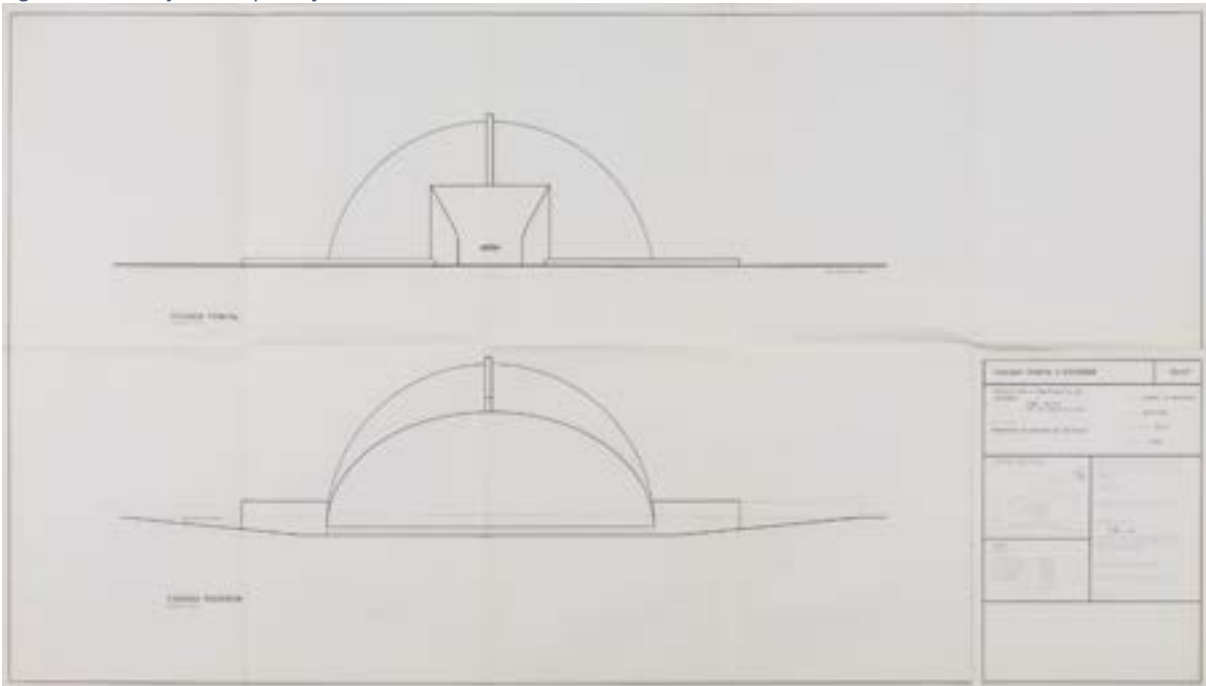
Projeto de aprovação – Corte longitudinal – foto Rafael Schimidt – fonte: Acervo do DEPAVE
